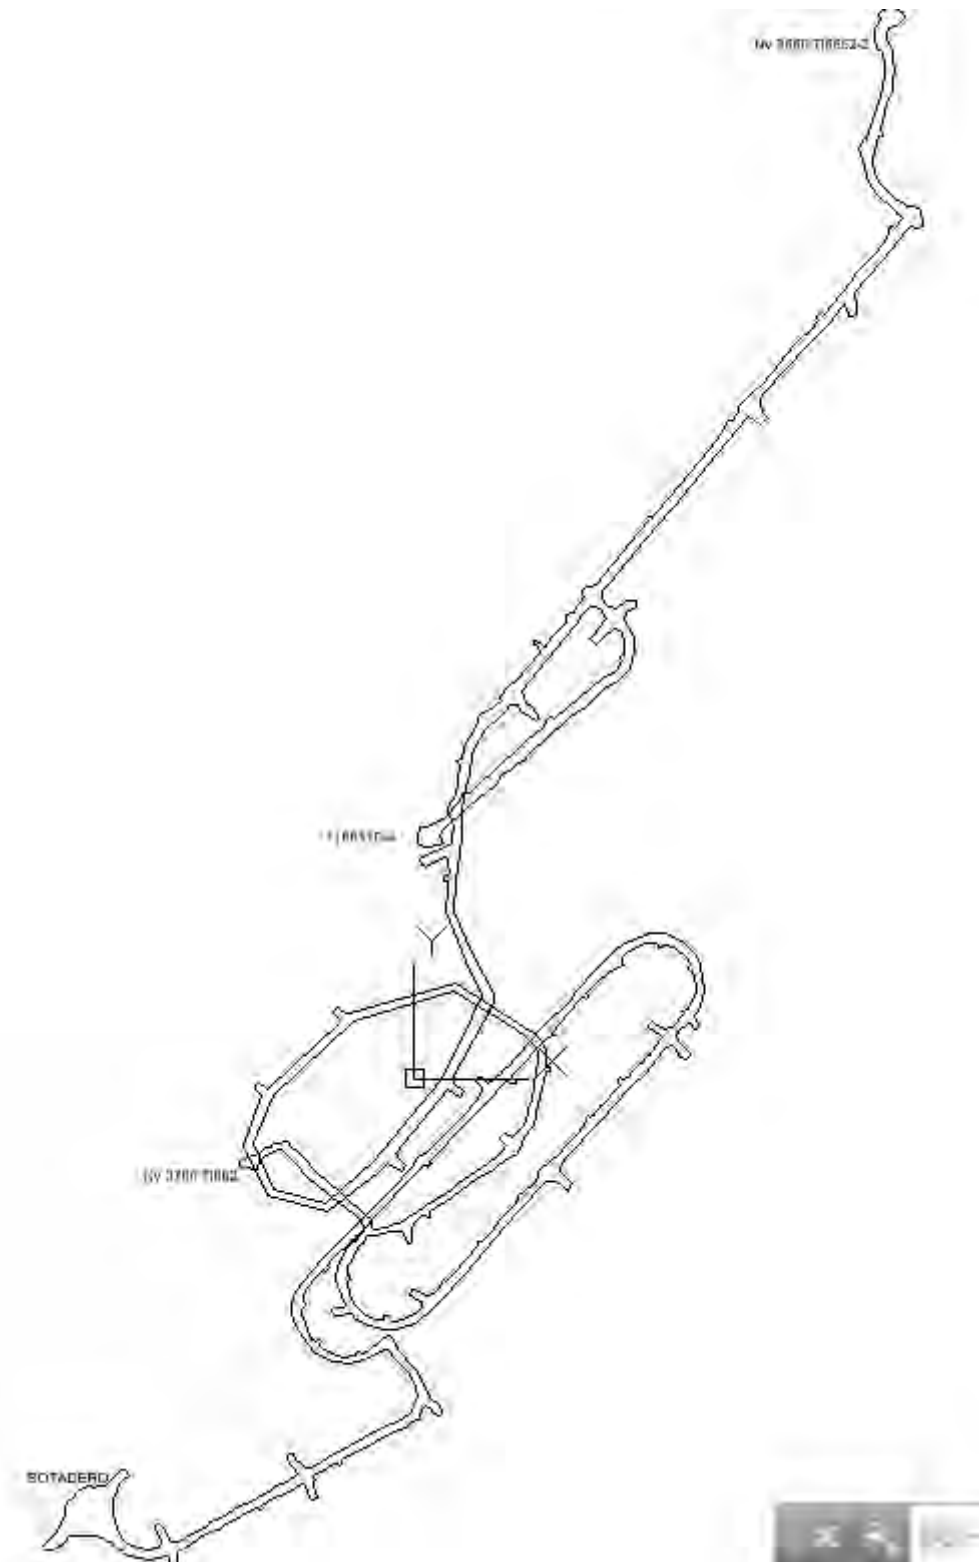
Topografía desde el punto de descarga hasta las labores de extracción. Vista planta.
